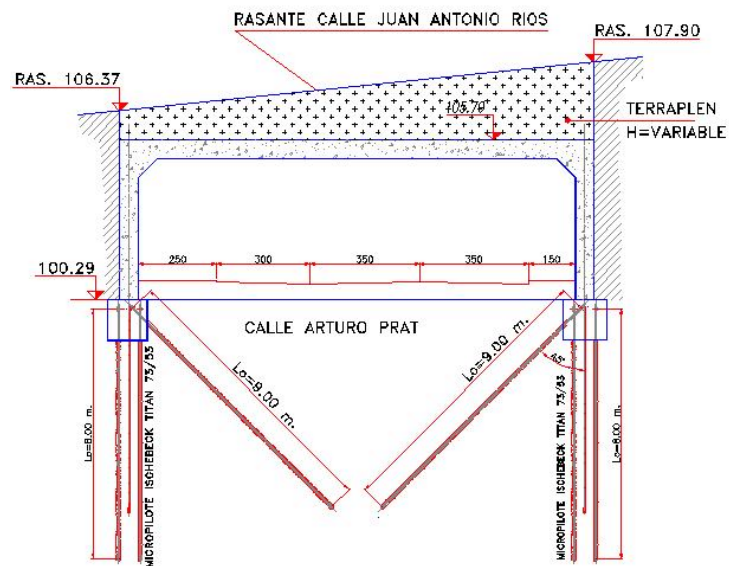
Sección transversal del paso inferior Camilo Olavarría
